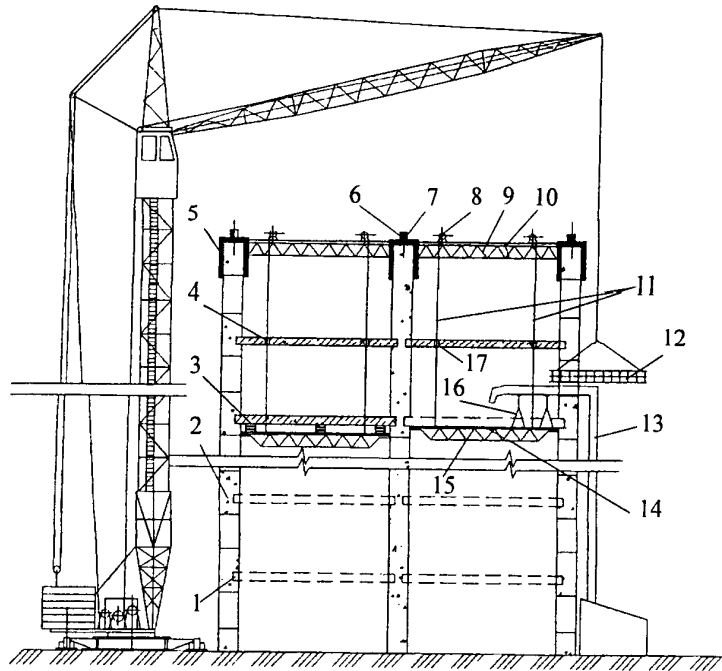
Бетонування плит перекриття в напрямку «згори-вниз» при зведенні стін в ковзній опалубці:
